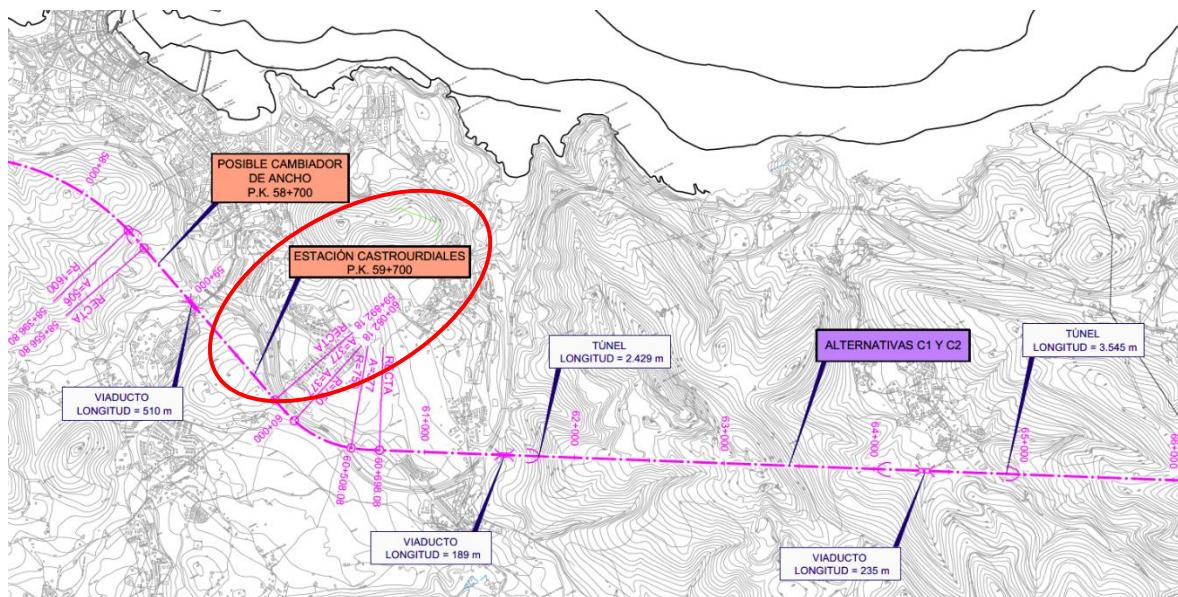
Estación Castro Urdiales en planta de Alternativa C1 y C2
